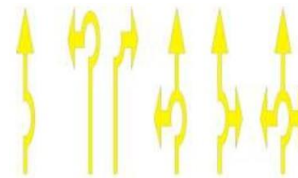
Pravilna upotreba traka pri polukružnom okretanju
